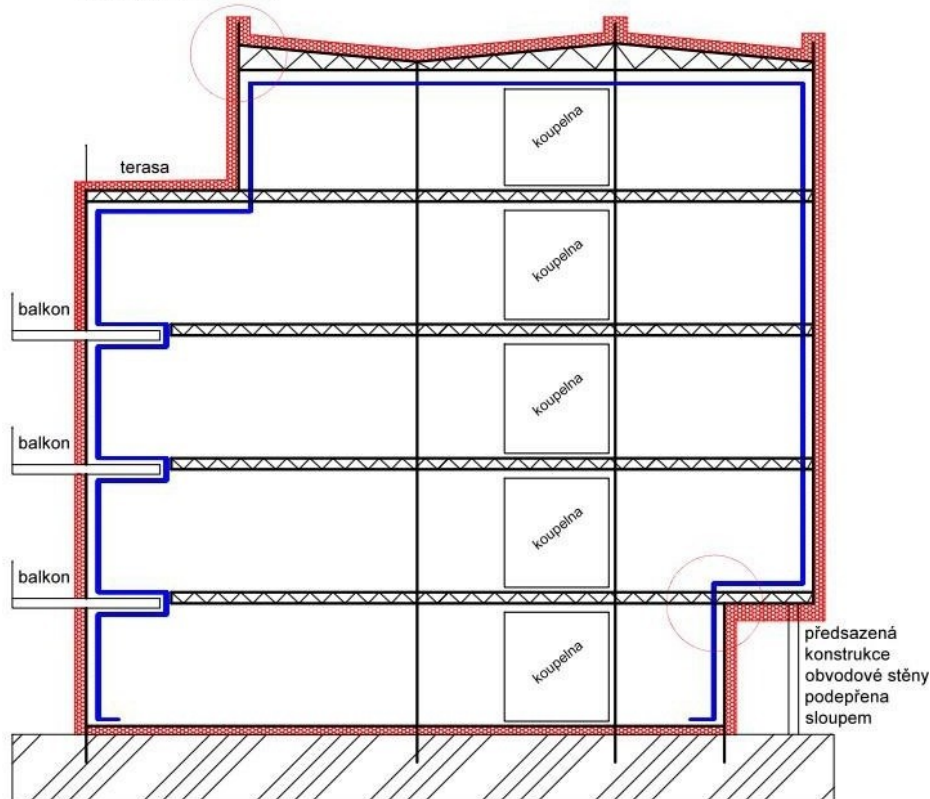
UMÍSTĚNÍ ROVINY PAROZÁBRANY A TEPELNÉ IZOLACE V KONSTRUKCI, U
